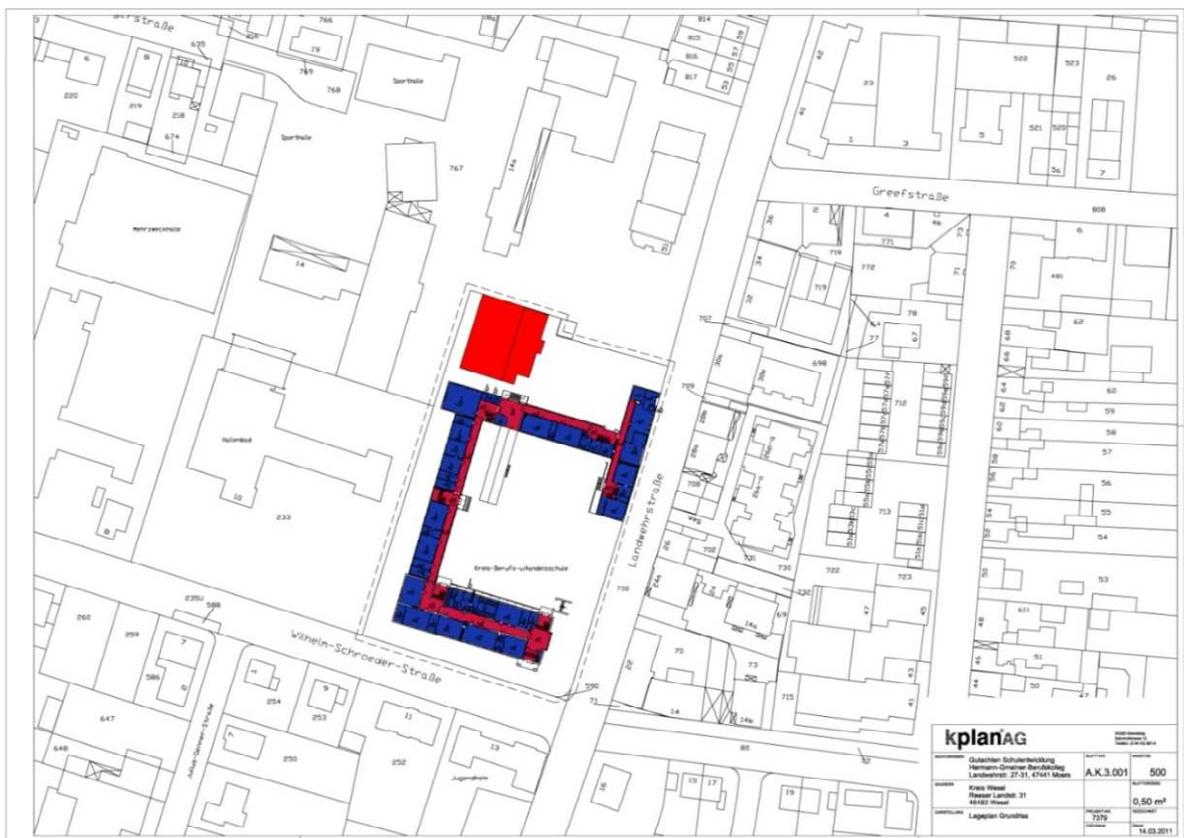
Grundriss und Umgriff Hermann-Gmeiner-Berufskolleg
